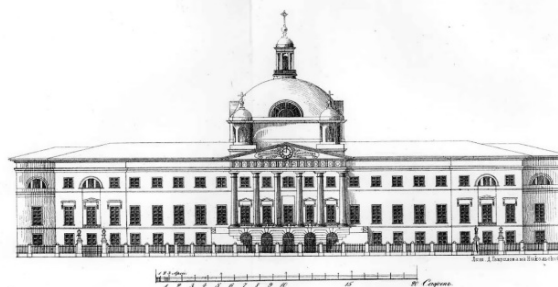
Главный фасад главного корпуса Голицынской больницы
